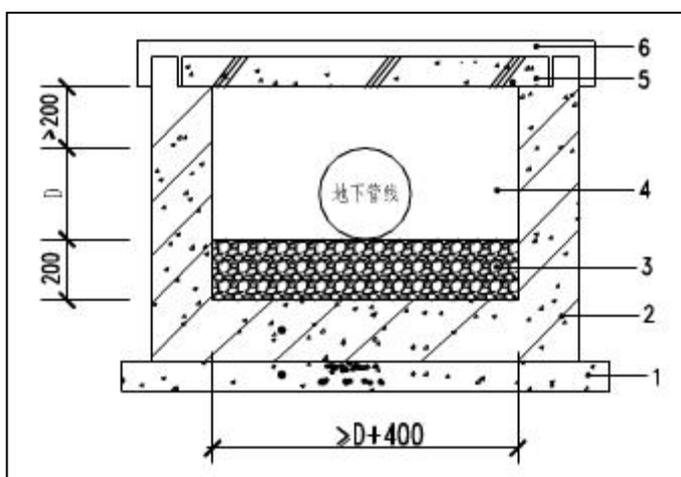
抗渗钢筋混凝土管沟防渗层示意图
